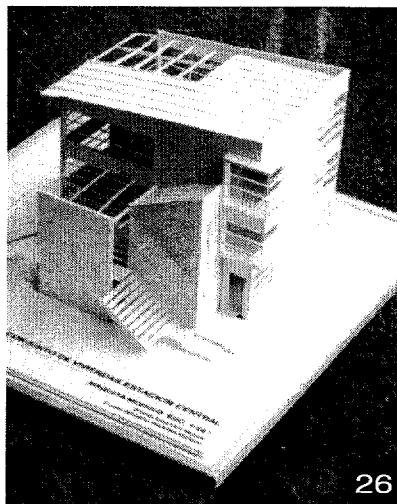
IMAGEN MODELO DE AMARRE, FACHADA HACIA LA CALLE, ESTE CONTIENE LAS TRES TIPOLOGIAS APLICADAS.
